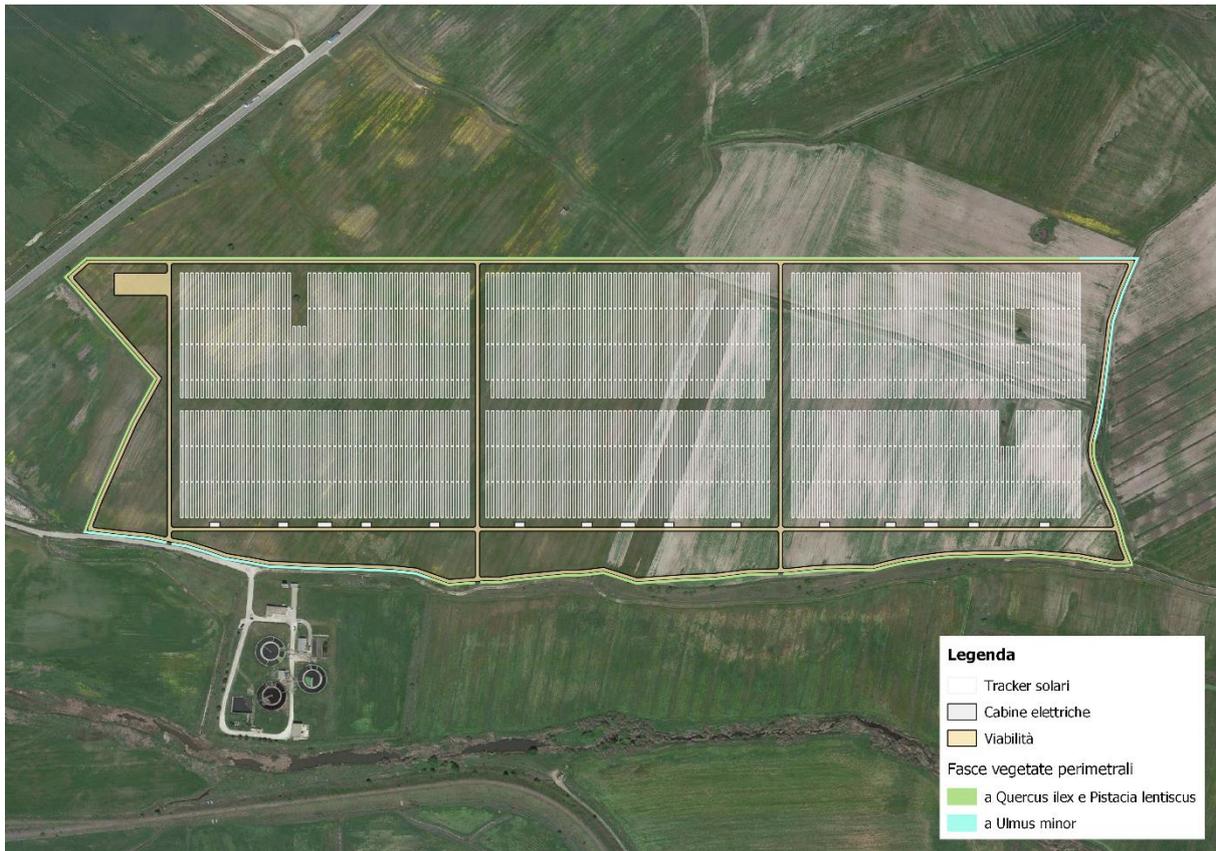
Disposizione delle fasce vegetate rispetto al layout progettuale del campo fotovoltaico
